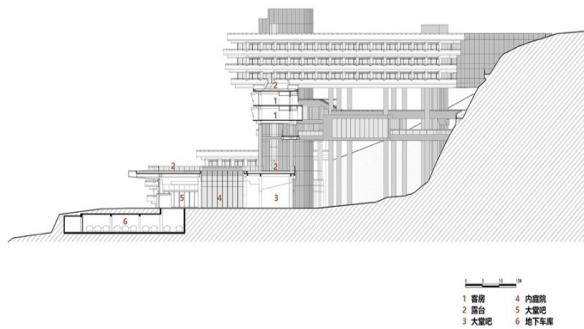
Разрез Отеля Xuzhou Garden Expo Park Dangkou. <https://www.goood.cn/xuzhou-garden-expo-park-dangkou-hotel-by-cctn-architectural-design.htm> (дата обращения: 06.08.2024)
